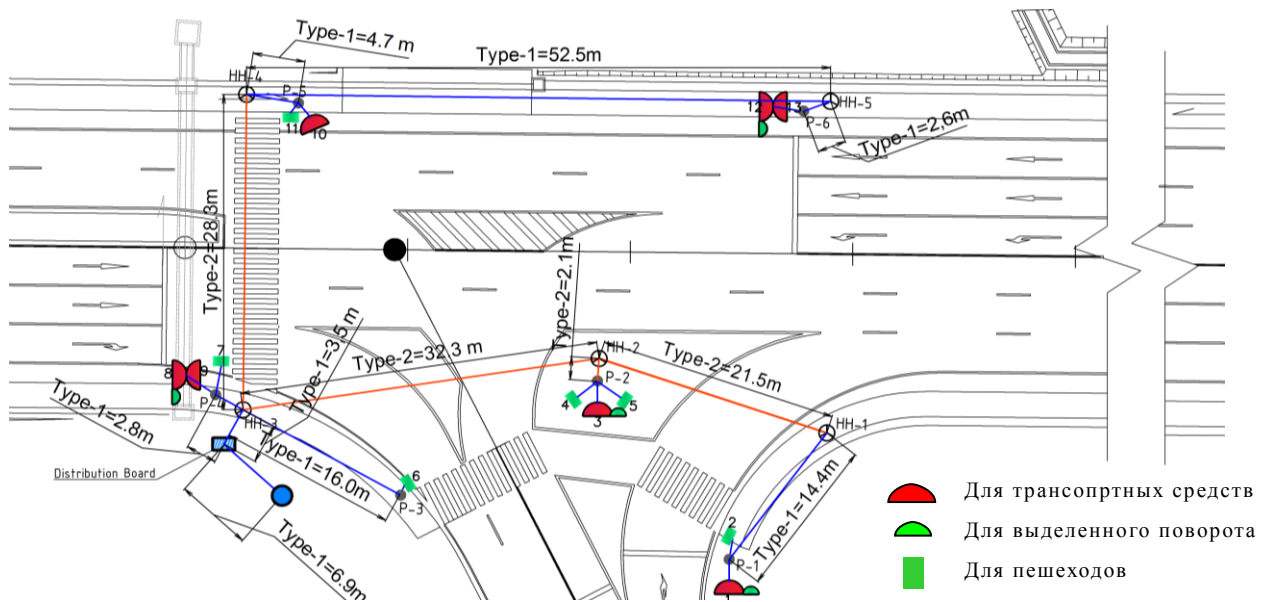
Перекресток-02 (ПК 820) [1/2]
